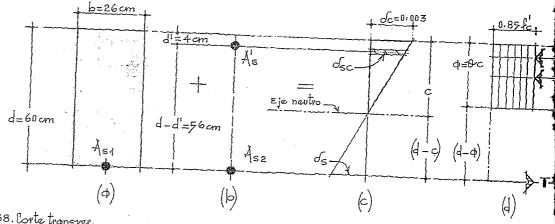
Corte tronsversol de la viga, (4). Fig. 4.39. Areas de acero en compresión y entensión complementaria, (b). Fig. 4.40. De formaciones en la viga, (c).
